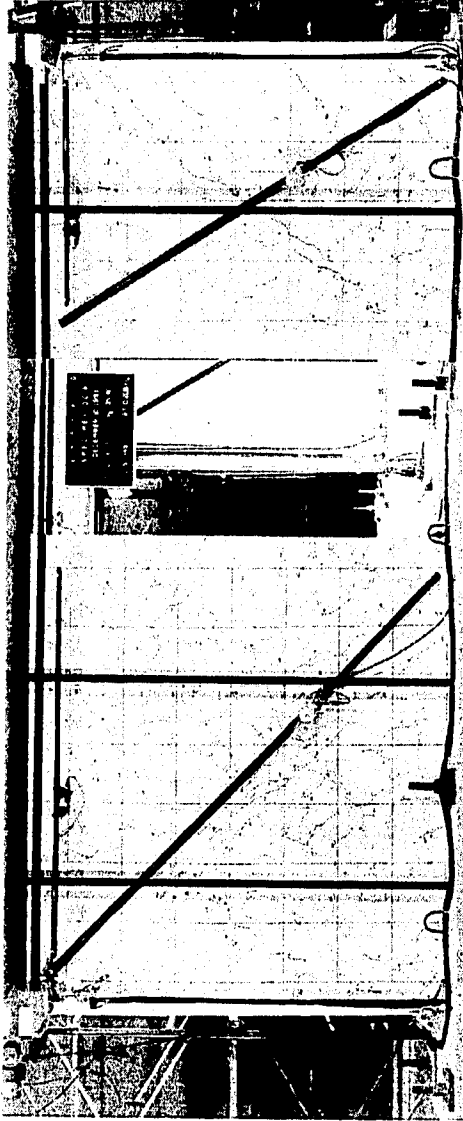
Patrón de Agrietamiento del Muro Norte N1;
